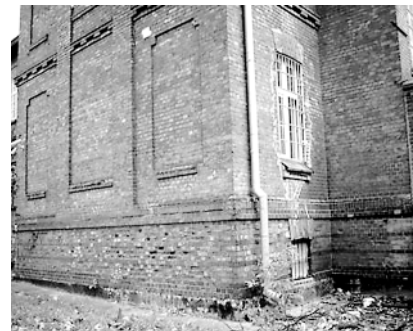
, 6. Stan techniczny ceglanych elewacji pawilonu
